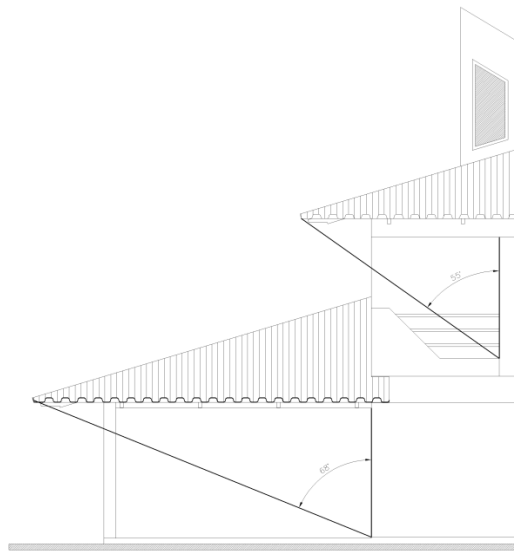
Projeto 4- Fachada norte – ângulo de proteção do elemento horizontal na fachada leste.
